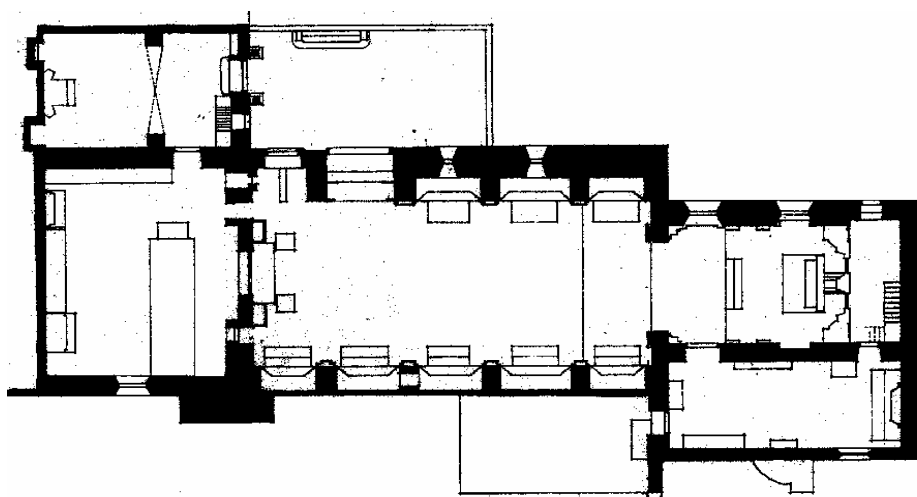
Planta da igreja de Santa Clara (Porto) [3]
